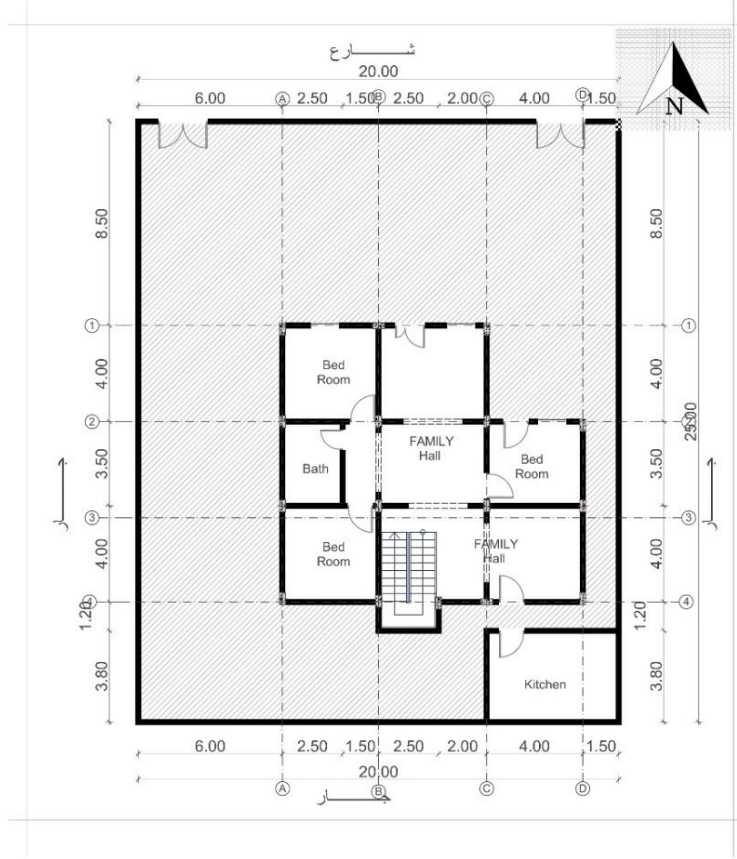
مسقط أفقي لحالة الدراسة السابعة (المصدر: الباحثة)
